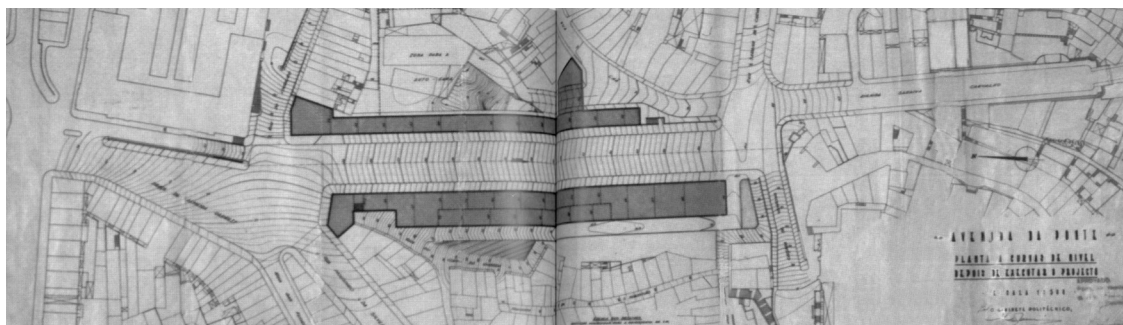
Eng.º Bonfim Barreiros - Projecto para a Avenida da Ponte.
